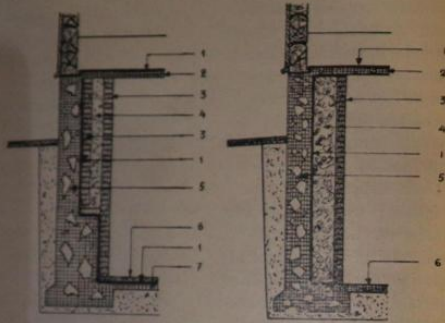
Säästöbetoniseinä, osa laipio- ja lattiarakennetta, 1 täyte, 2 eristys, 3 betonilaipio, 4 säästöbetoniseinä, 5 betonilattia.
